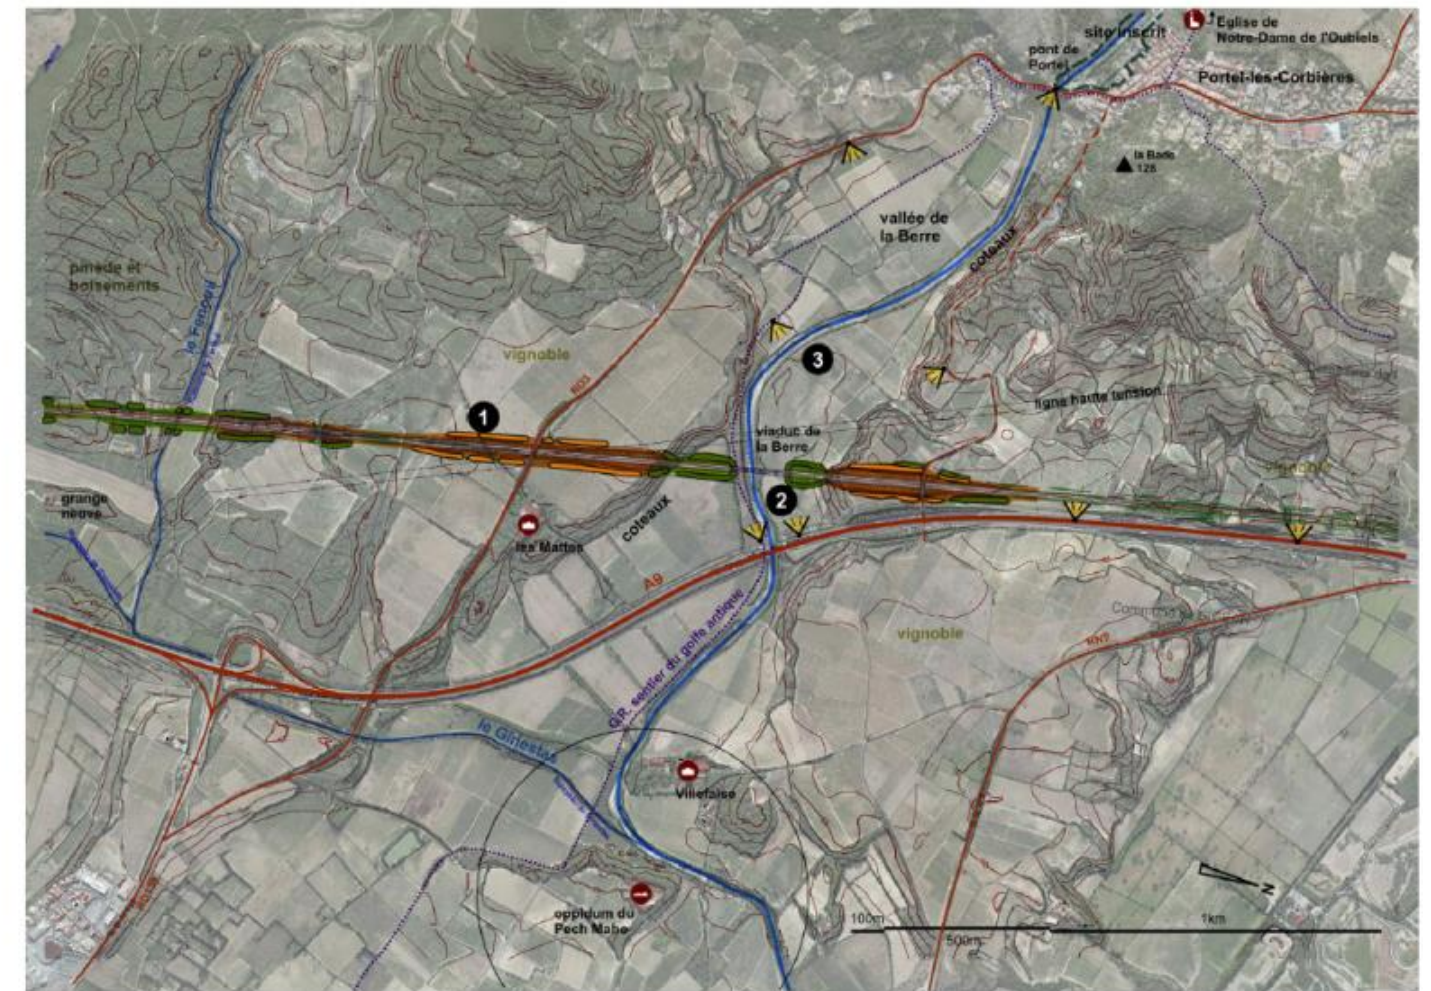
plan des mesures paysagères dans la traversée de la vallée de la Berre (source : Traverses)
